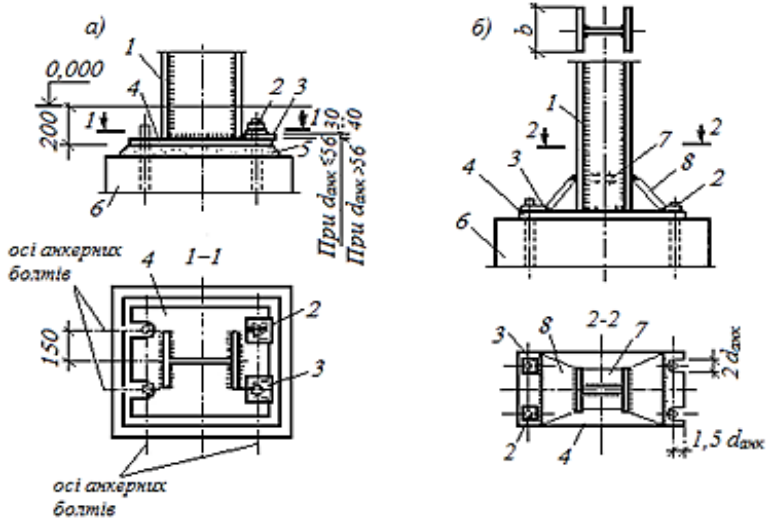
Монолітні залізобетонні фундаменти під сталеві колони, бази яких виконані у вигляді опорних (а) або опорних і розкісних плит (б): 1 – сталеві колони; 2 – анкерний стержень (з гайкою і шайбою); 3 – анкерна плита; 4 – опорна плита; 5 – цементна стяжка (цементний розчин 1:2); 6 – залізобетонний фундамент; 7 – ребро жорсткості; 8 – розкісна плита
